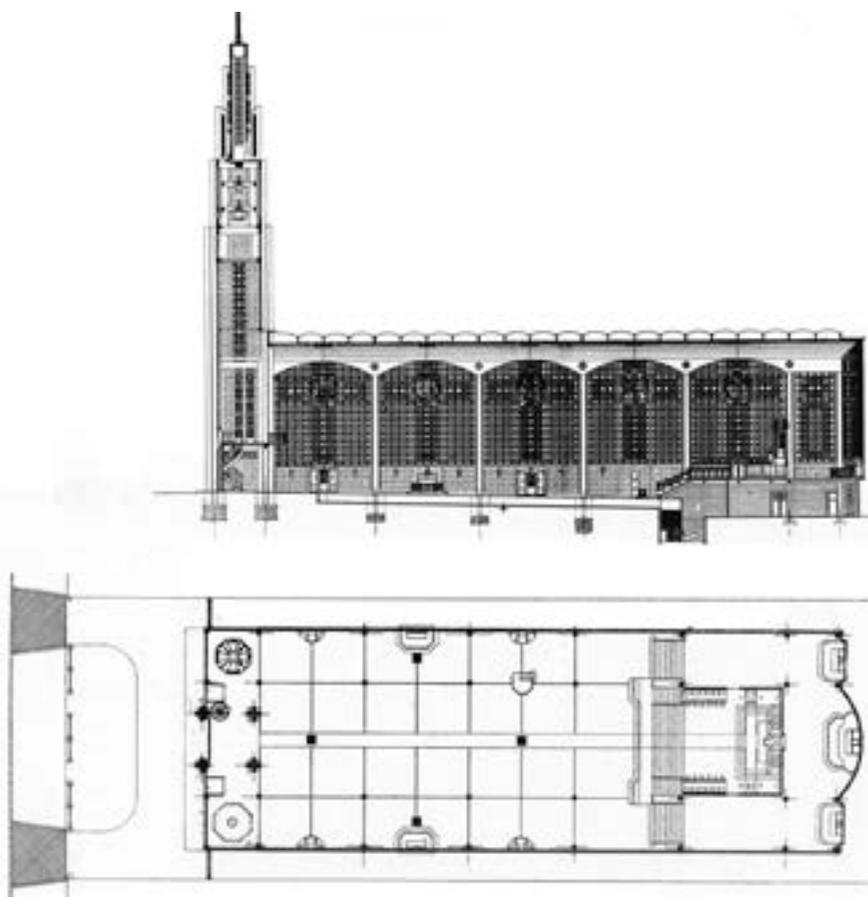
August Perret, Notre Dame de Raincy. Corte y Planta.
